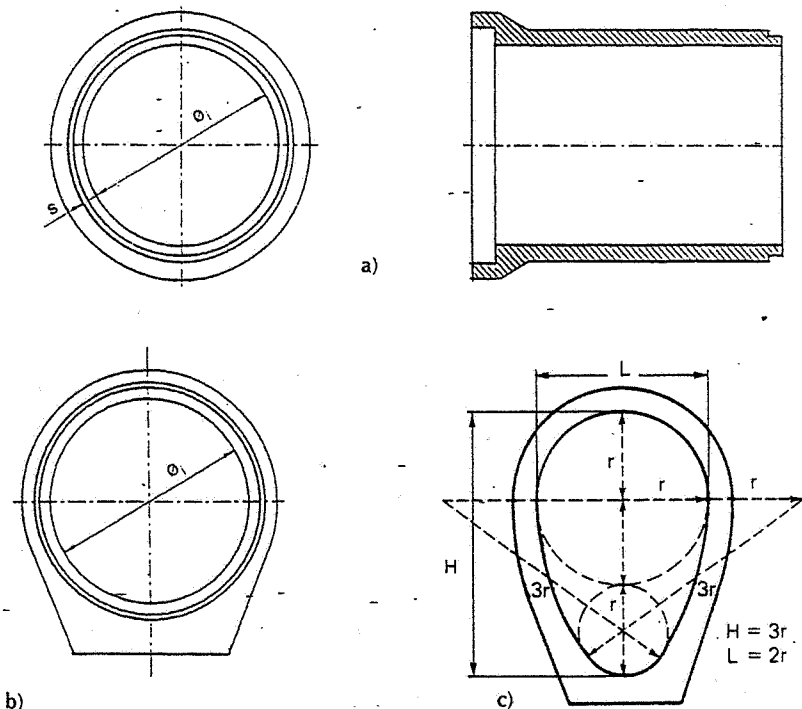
Tubi di calcestruzzo: a) a sezione circolare, senza piede di appoggio, con giunto a bicchiere; b) a sezione circolare con piede di appoggio; c) a sezione ovoidale normale.
